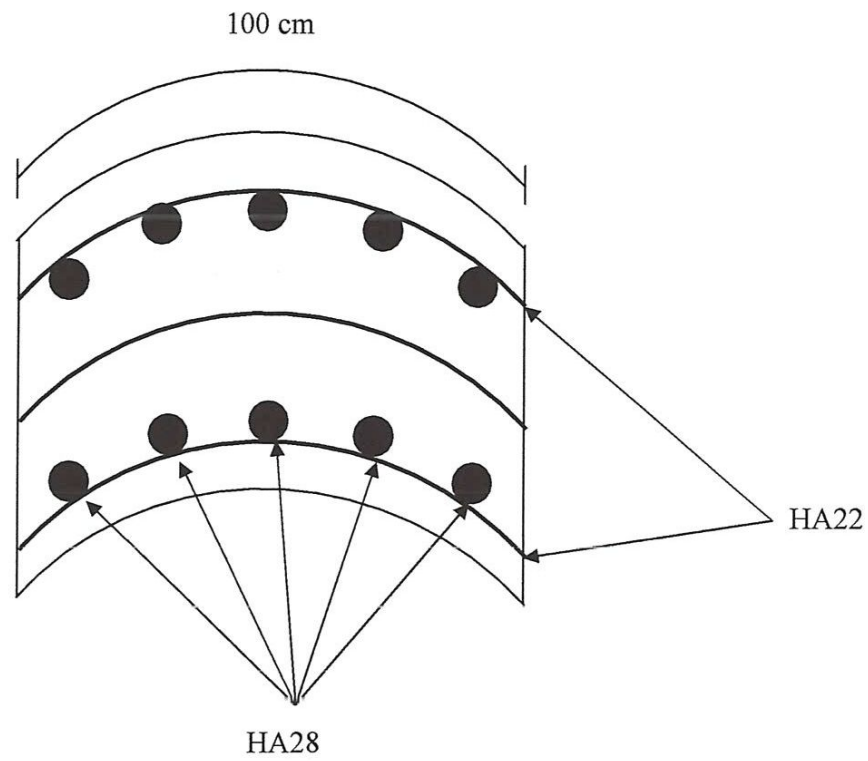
schéma montre le ferrailage de la variante précontrainte (horizontal et vertical)
